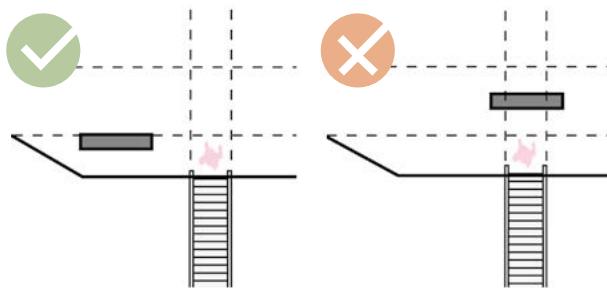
Voorbeeld uitwerking rustpunt met trap.
